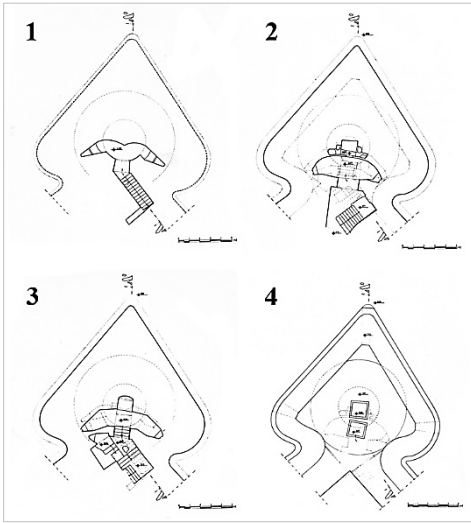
Puntone Santa Maria Maddalena: rilievo-progetto: 1 pianta quota - 4.70; 2 pianta quota + 0.30; 3 pianta quota + 3.47; 4 pianta quota + 7.47 (Archivio Taddei, 1997).
